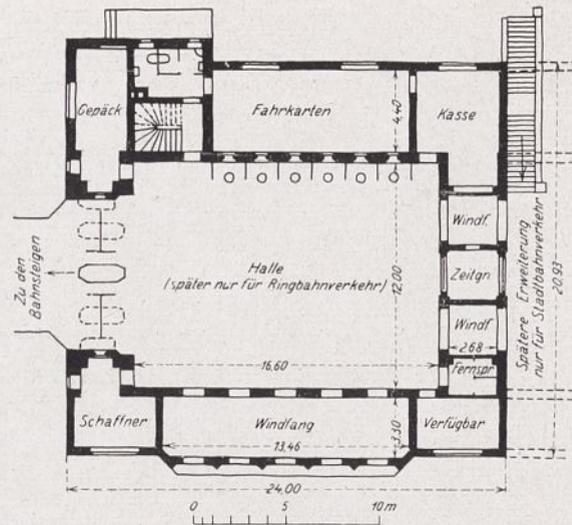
(rechts). Grundriß. M. 1 : 400.
